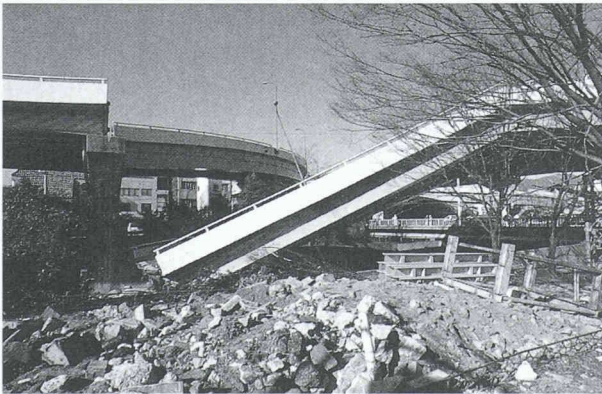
Chute d'une poutre porteuse sur un pont mixte béton-acier
